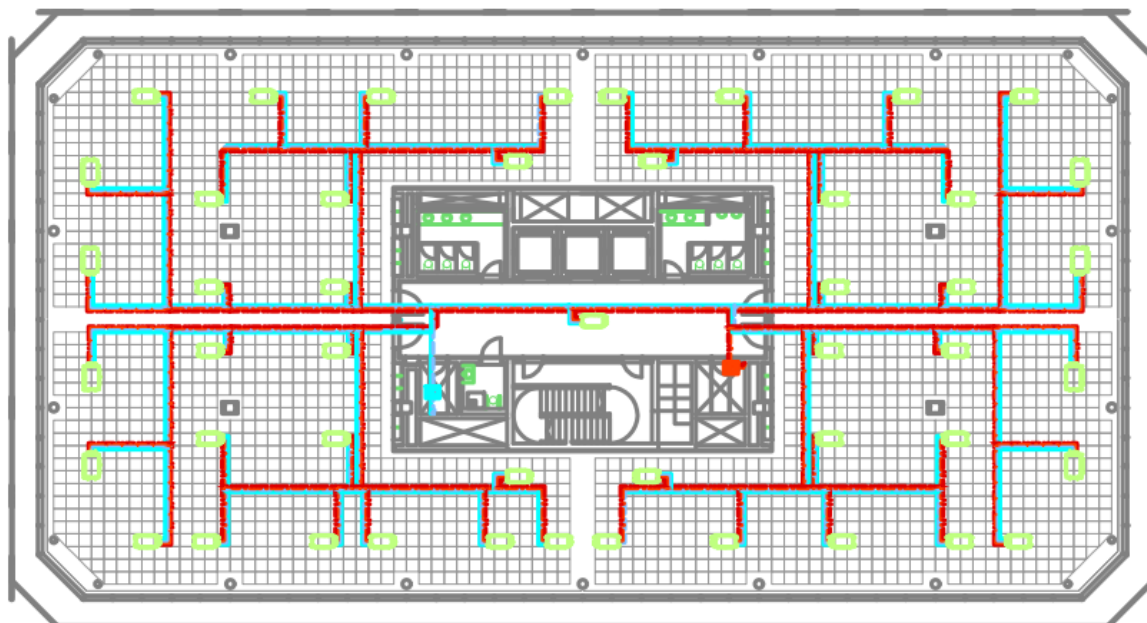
Red de tuberías Planta Segunda, Tercera y Cuarta
